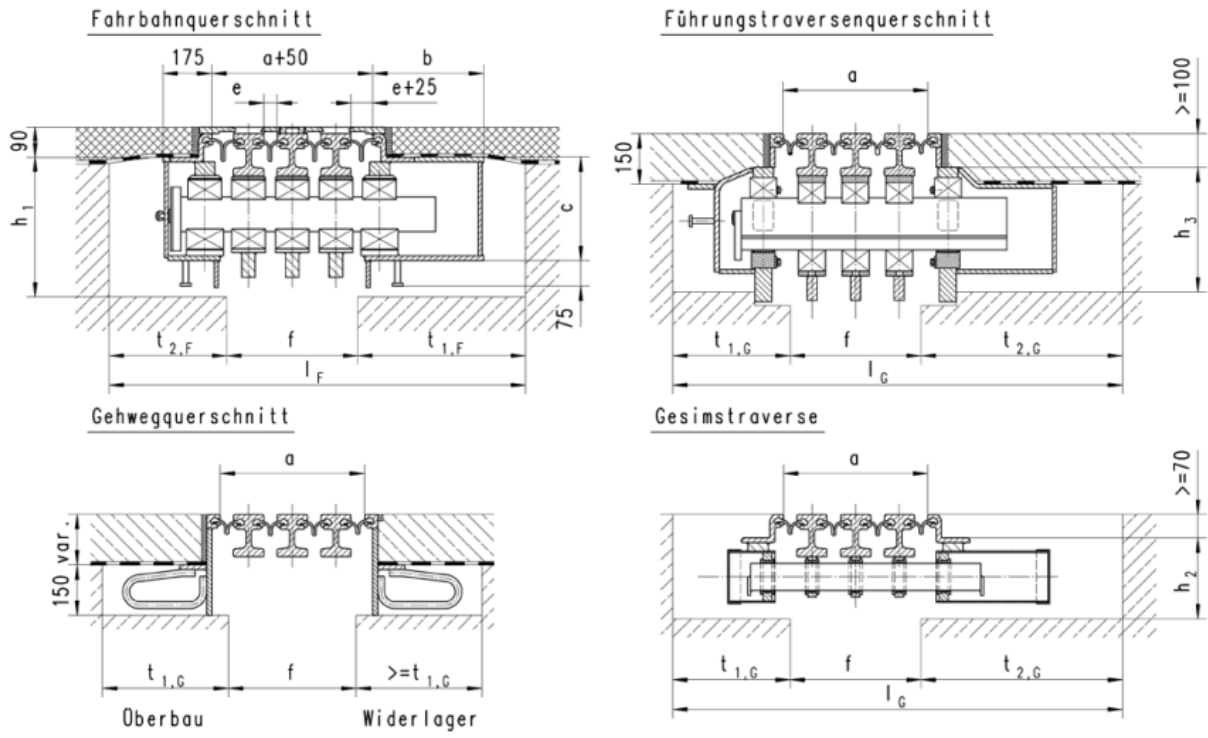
Coupe transversale – Zone chaussée et trottoir
